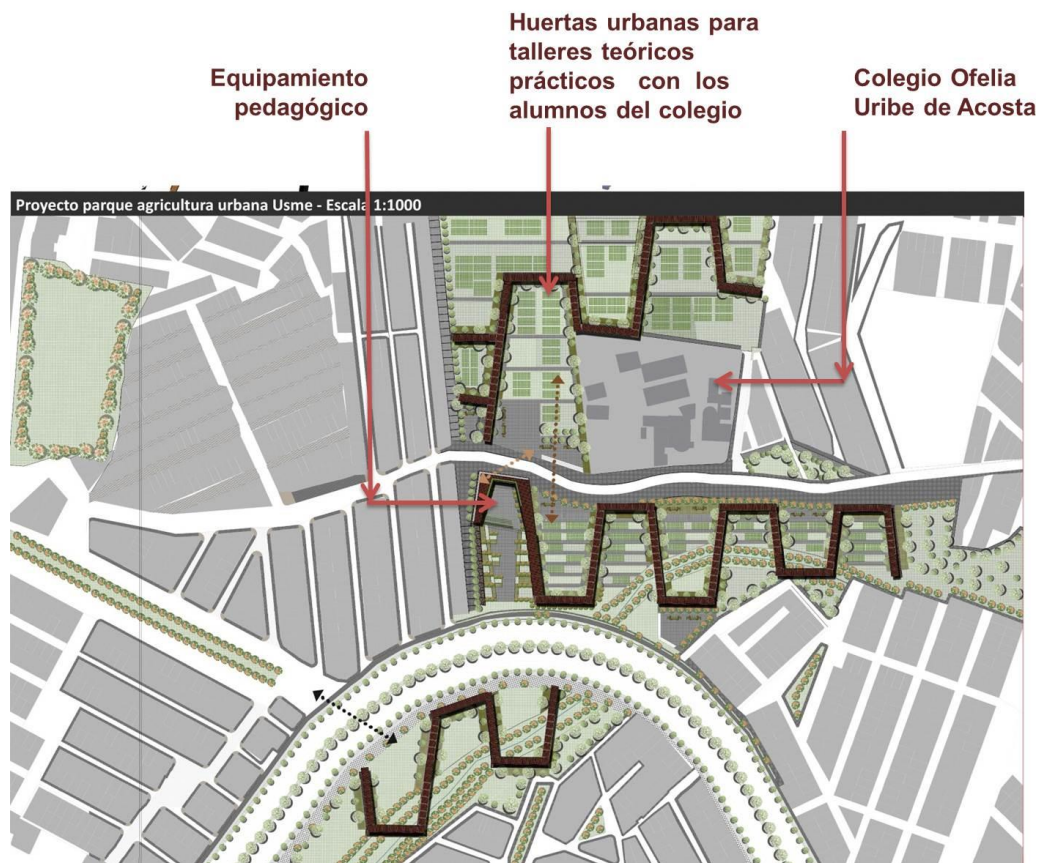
Planta de implantación a escala urbana. Fuente: Paola Caballero.
